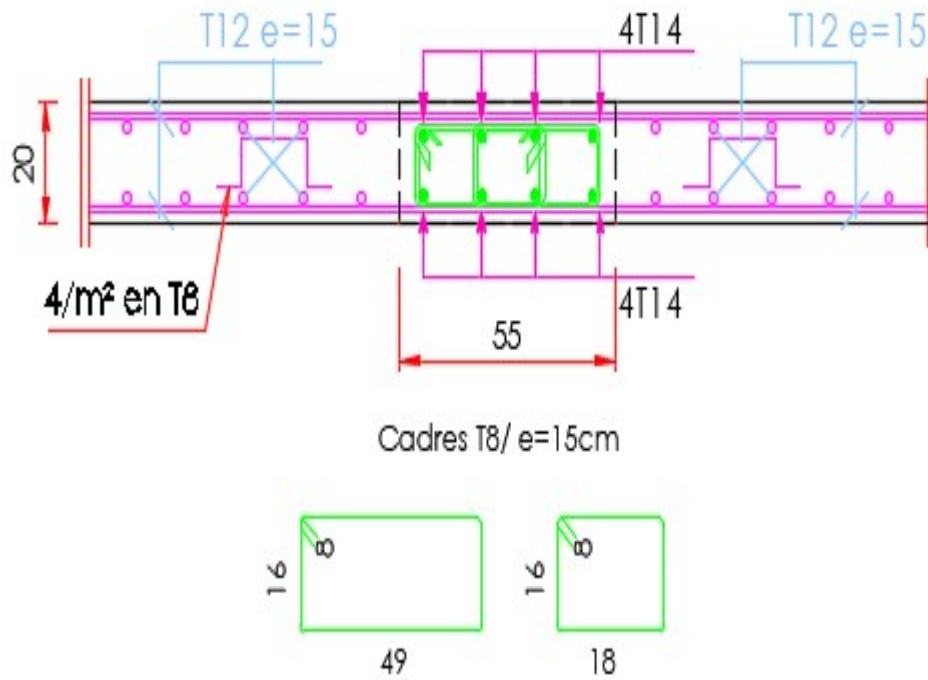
Schémas de ferrailage des poutres (22 x55) cm²
